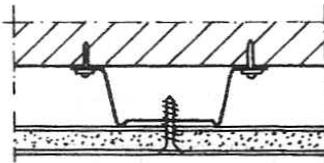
Habillage sur fourrure (coupe verticale ou horizontale)
